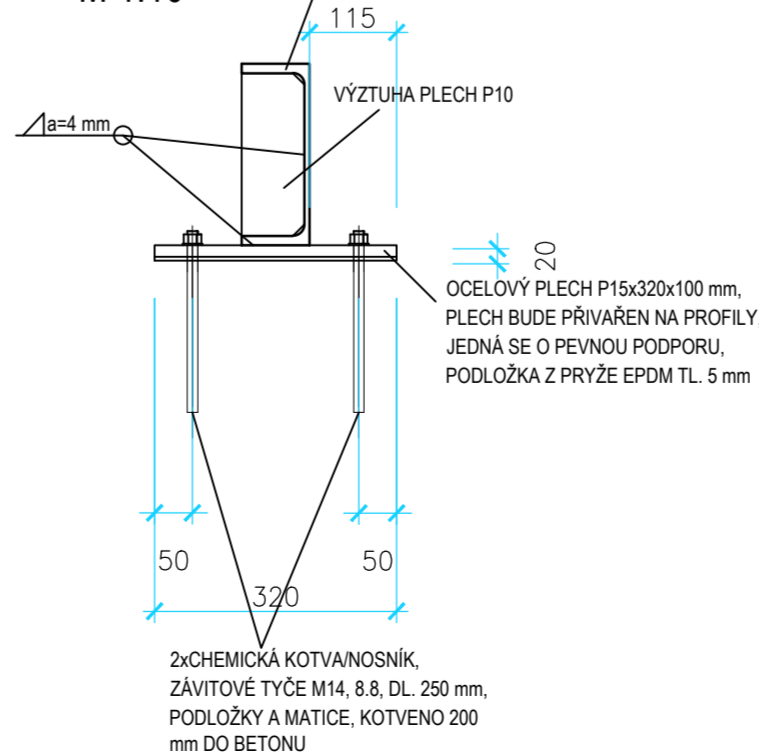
, PEVNÁ KLOUBOVÁ PODPORA,
